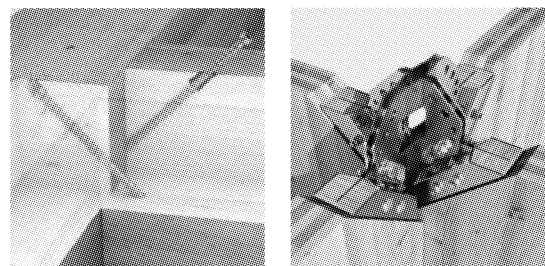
CLT 楼板-混凝土核心筒螺栓连接^[3]Fig. 3 CLT floor-concrete core-tube bolted connection^[3]a 抗拉锚固件^[8]
